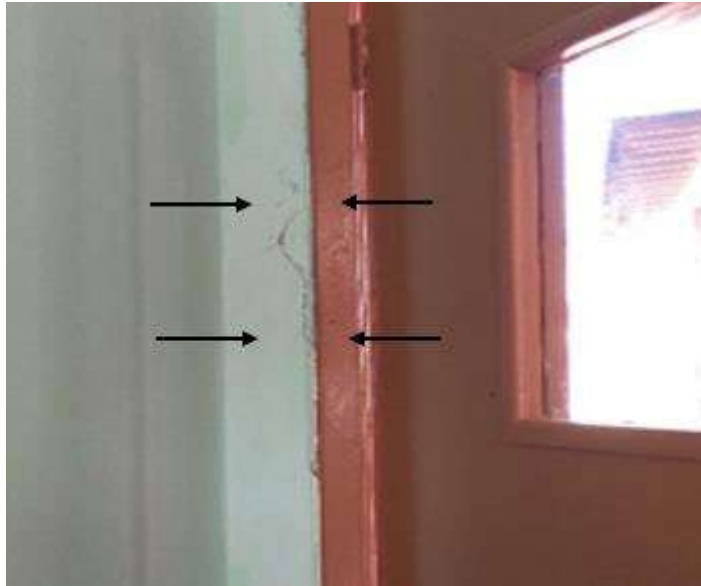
Fissura na região dos pontos de fixação de portas: Fissura em portas do edifício.
